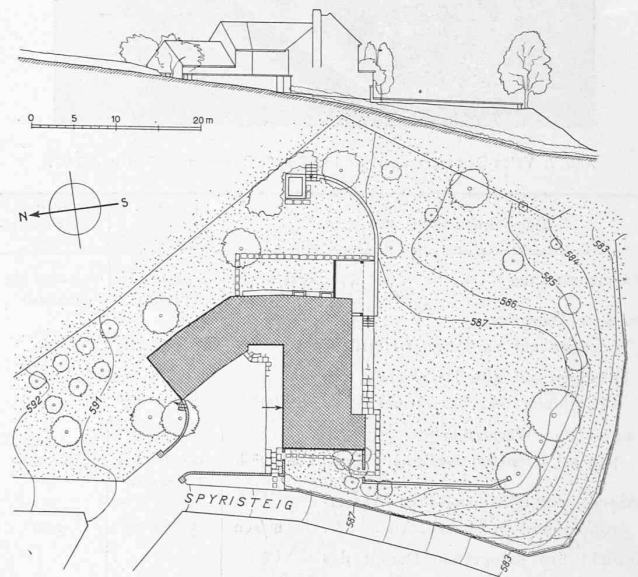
Lageplan mit Schnitt längs Spyristeig und Westansicht. — 1 : 800.
